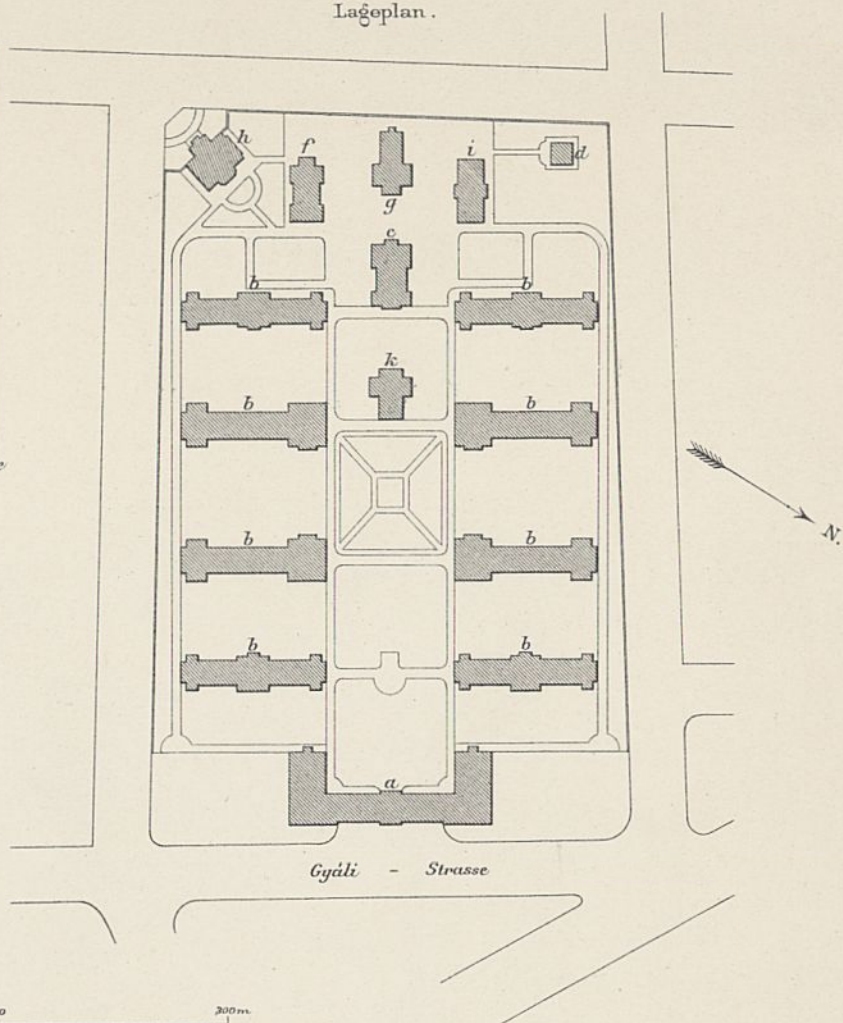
Allgemeines Krankenhaus in Budapest. Lageplan.
